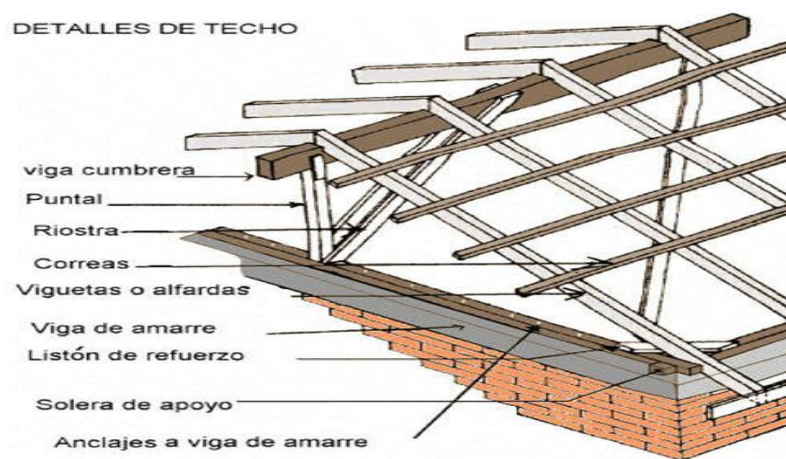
Detalles de la estructura básica de una cubierta³²
